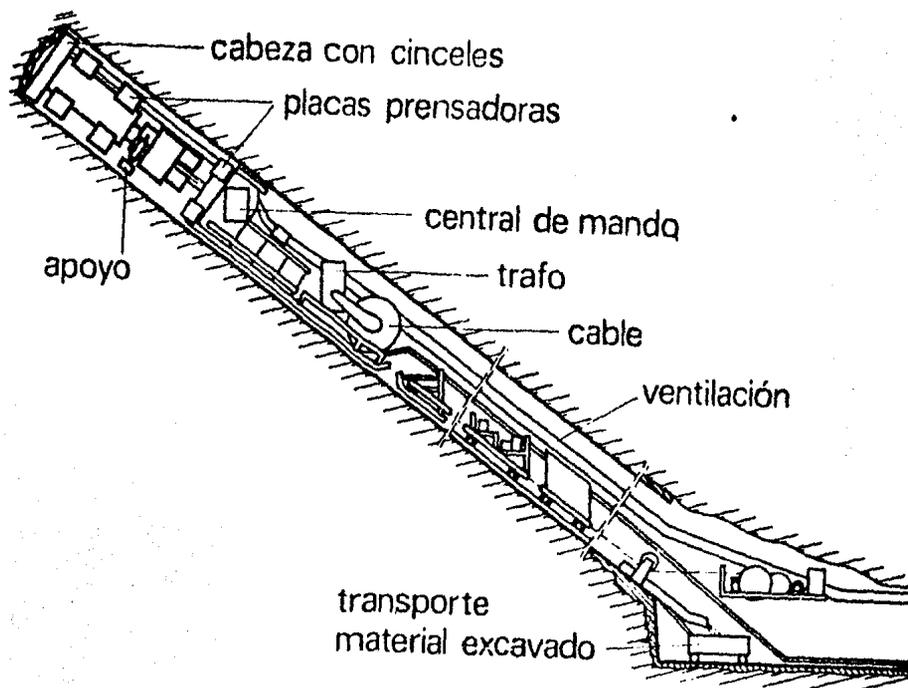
Esquemas de excavación mecanizada en galería inclinadas.
